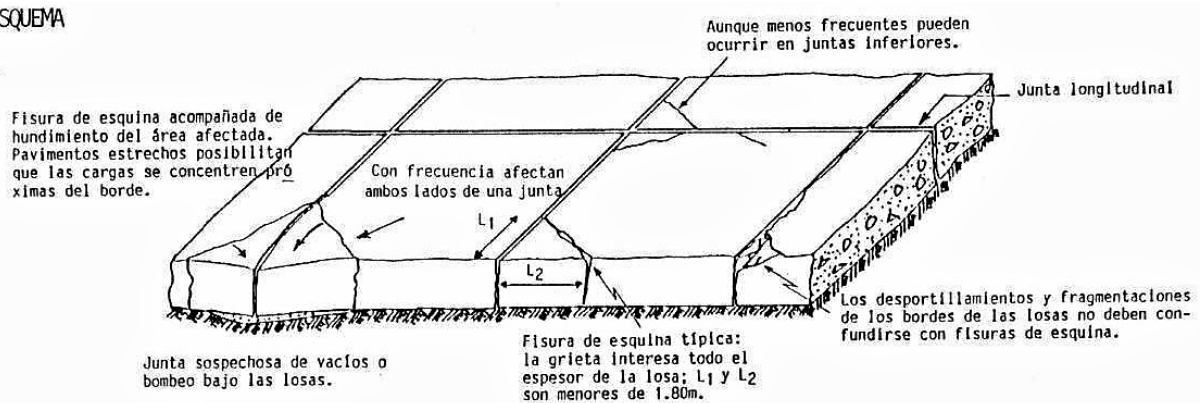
Esquema de fisuración de esquina. ¹²⁸
